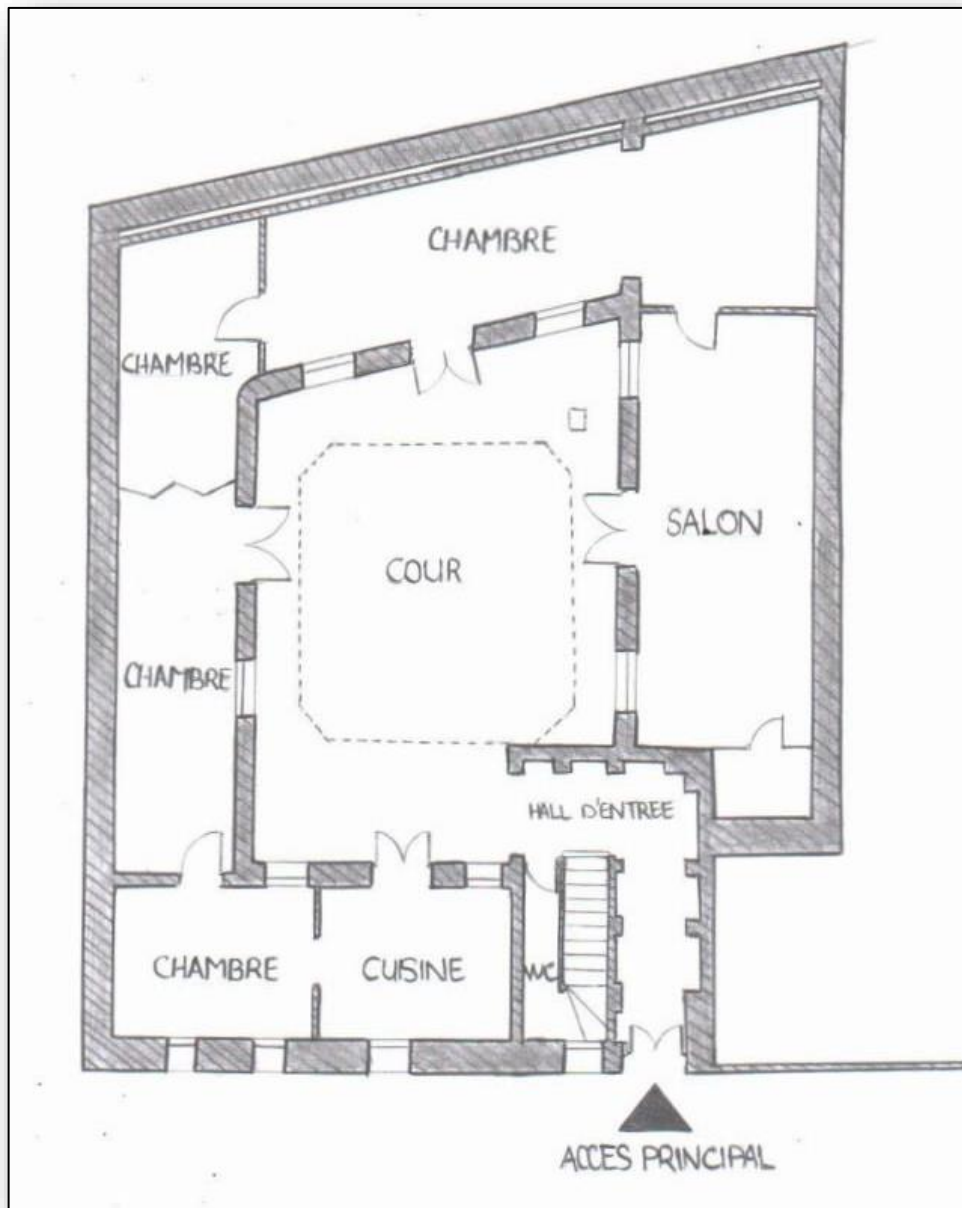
Plan Du R.D.C D'Une Demeure Traditionnelle Tlemcenienne.
